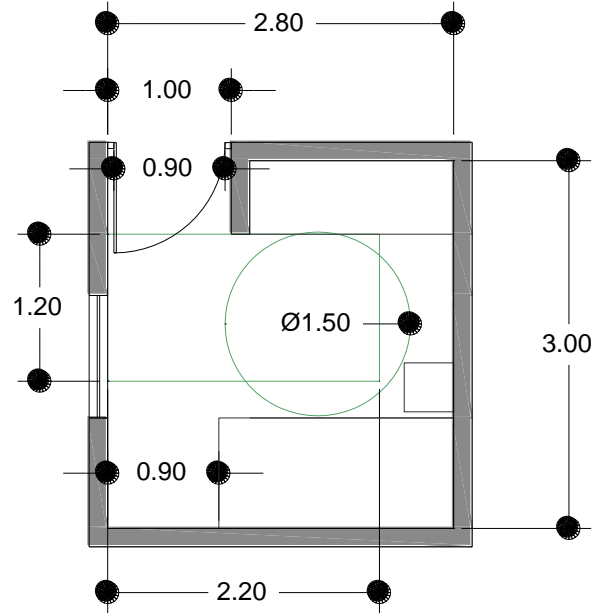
Propuesta de dimensionamiento para recámara 2. Permite giro de 360° con silla de ruedas y desplazamiento entre los muebles.
